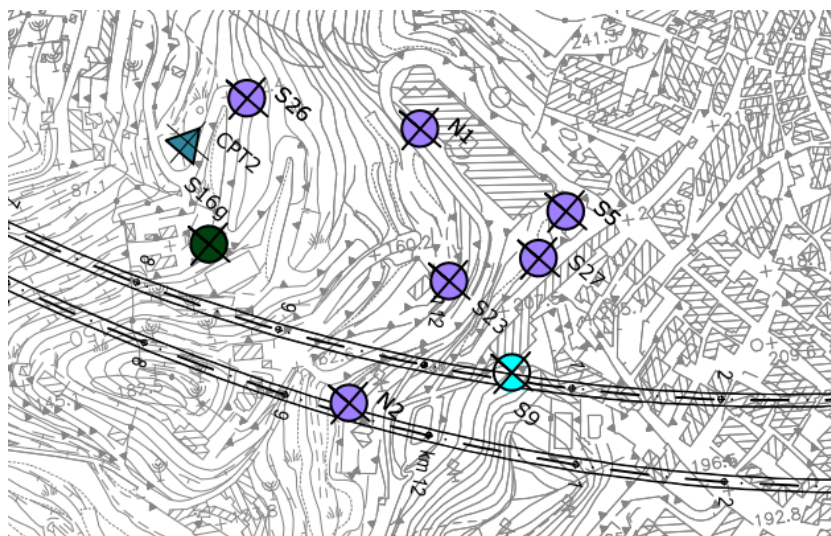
Planimetria con ubicazione del sondaggio S9.
